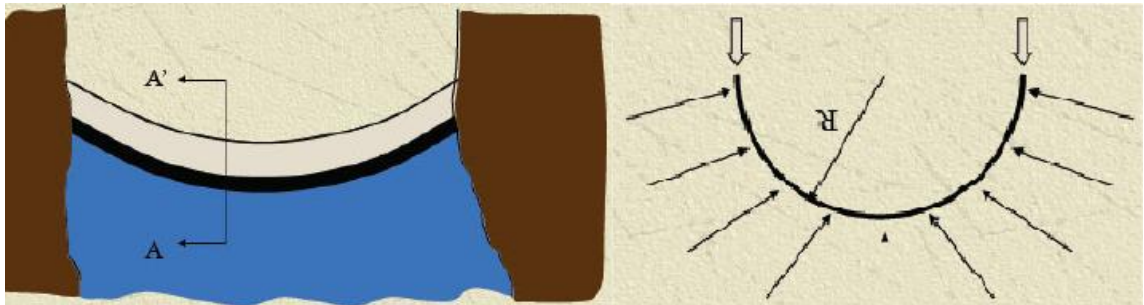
Esquema presa en arco tipo visto en planta. Fuente: blog de ingeniería.
